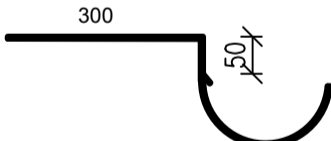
DETAIL A-OKAPOVÁ ČÁST STŘEŠNÍ KCE
